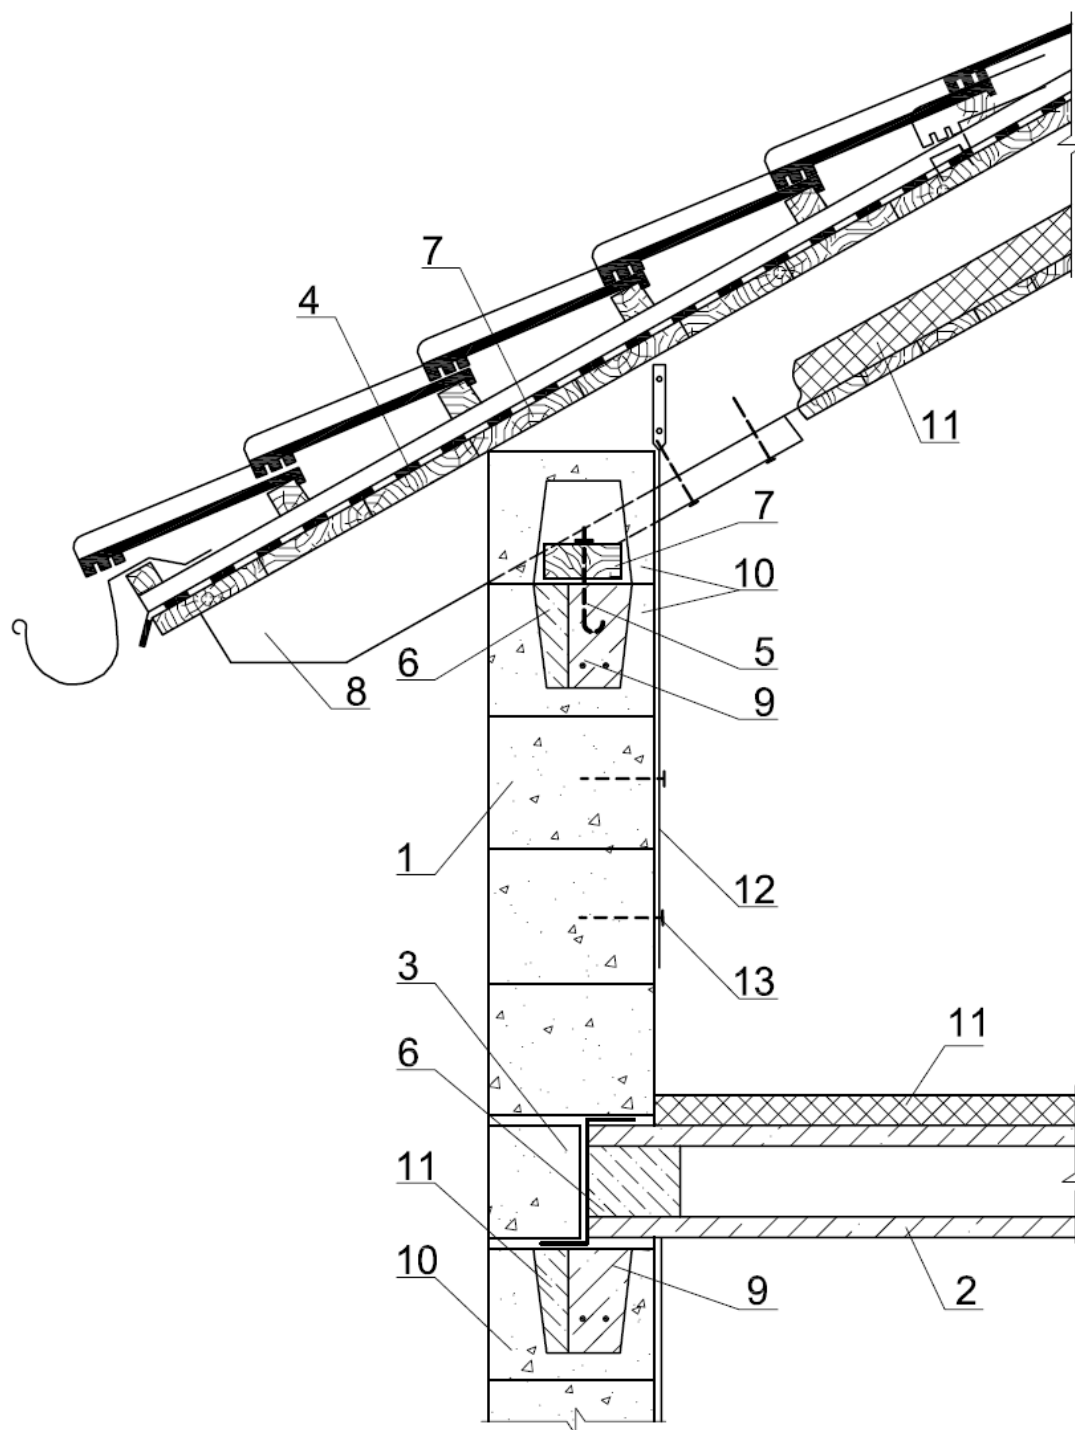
Примыкание самонесущей наружной стены из газобетонных блоков к железобетонной плите перекрытия
